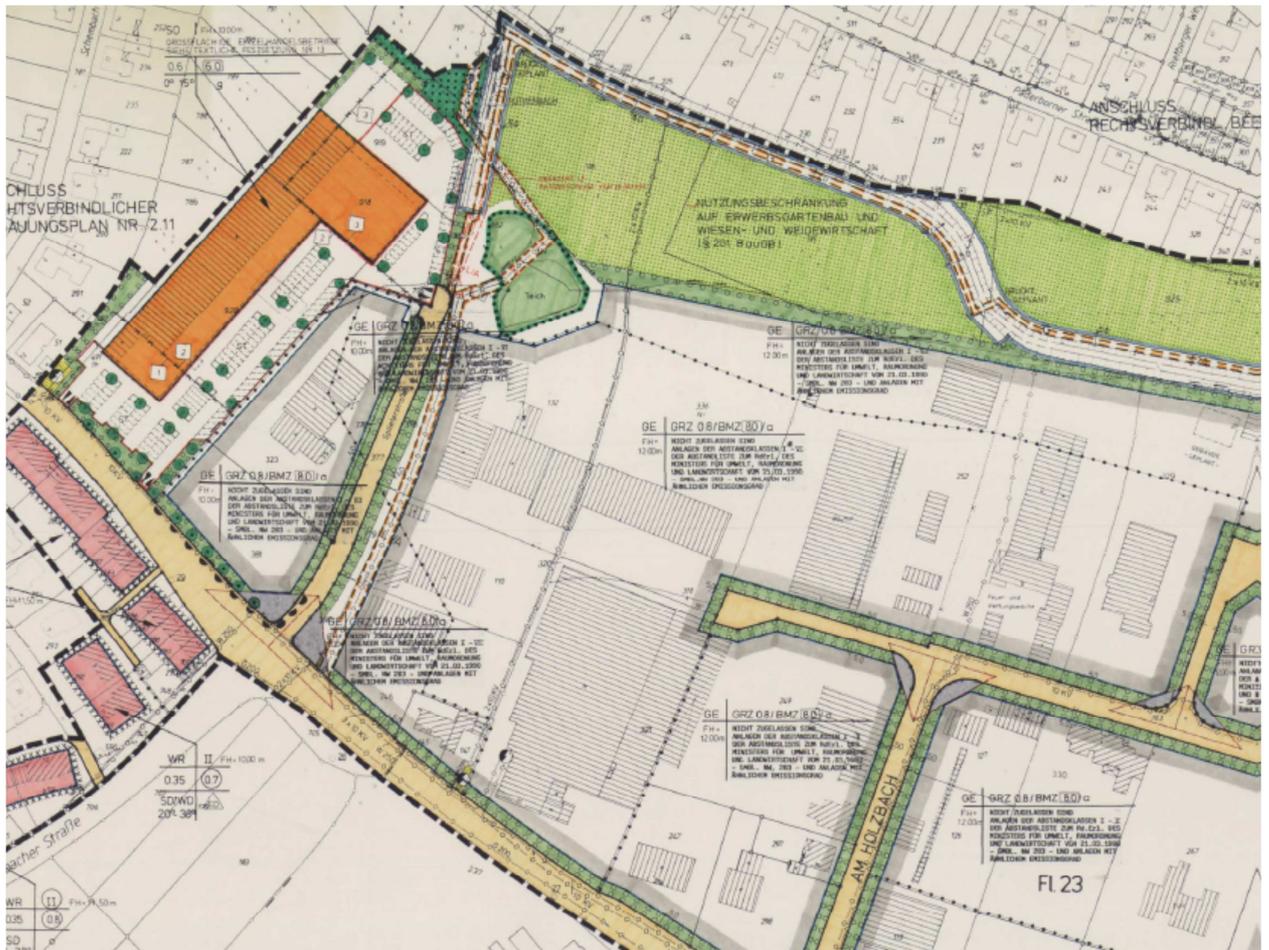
Relevanter Auszug aus dem Bebauungsplan Nr. 2.15
